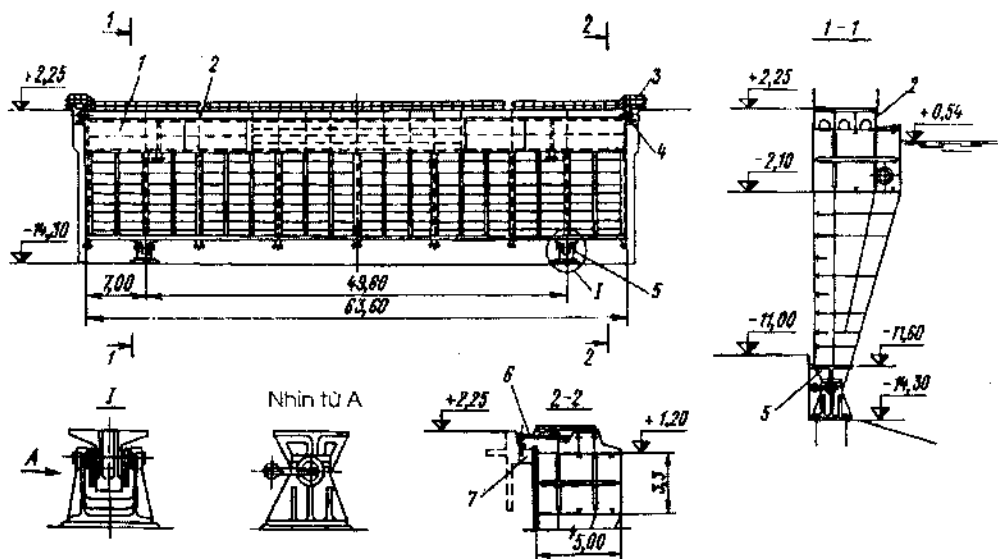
Sơ đồ bố trí và kết cấu cửa kéo ngang
